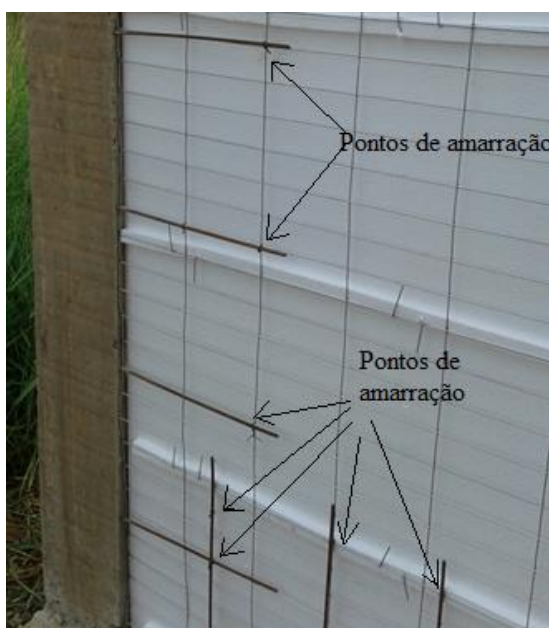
Detalhe da amarração das telas dos painéis aos arranques
